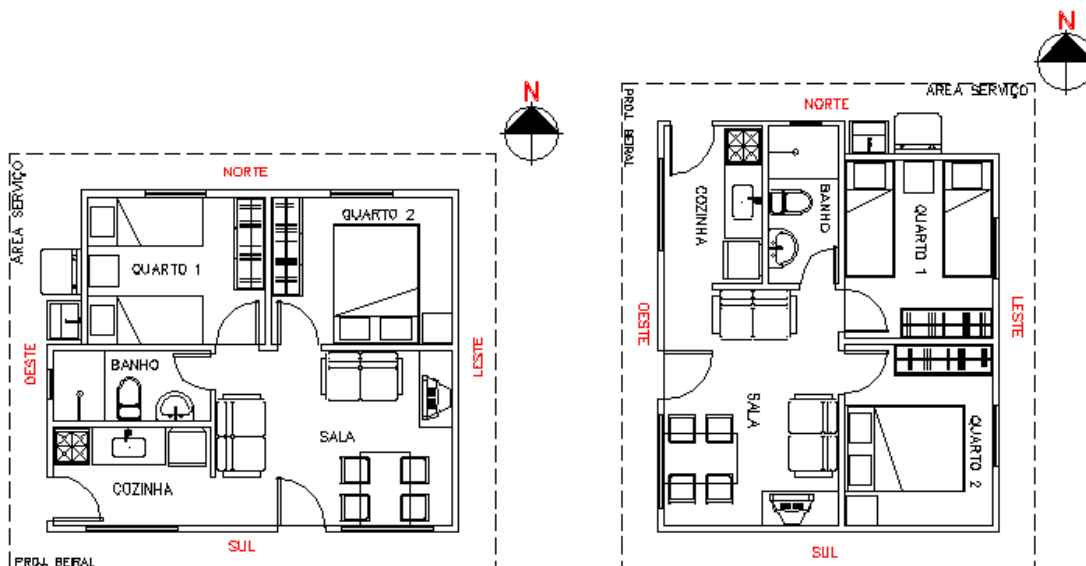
Orientação Solar 1 para Fachadas de aberturas Norte-Sul
